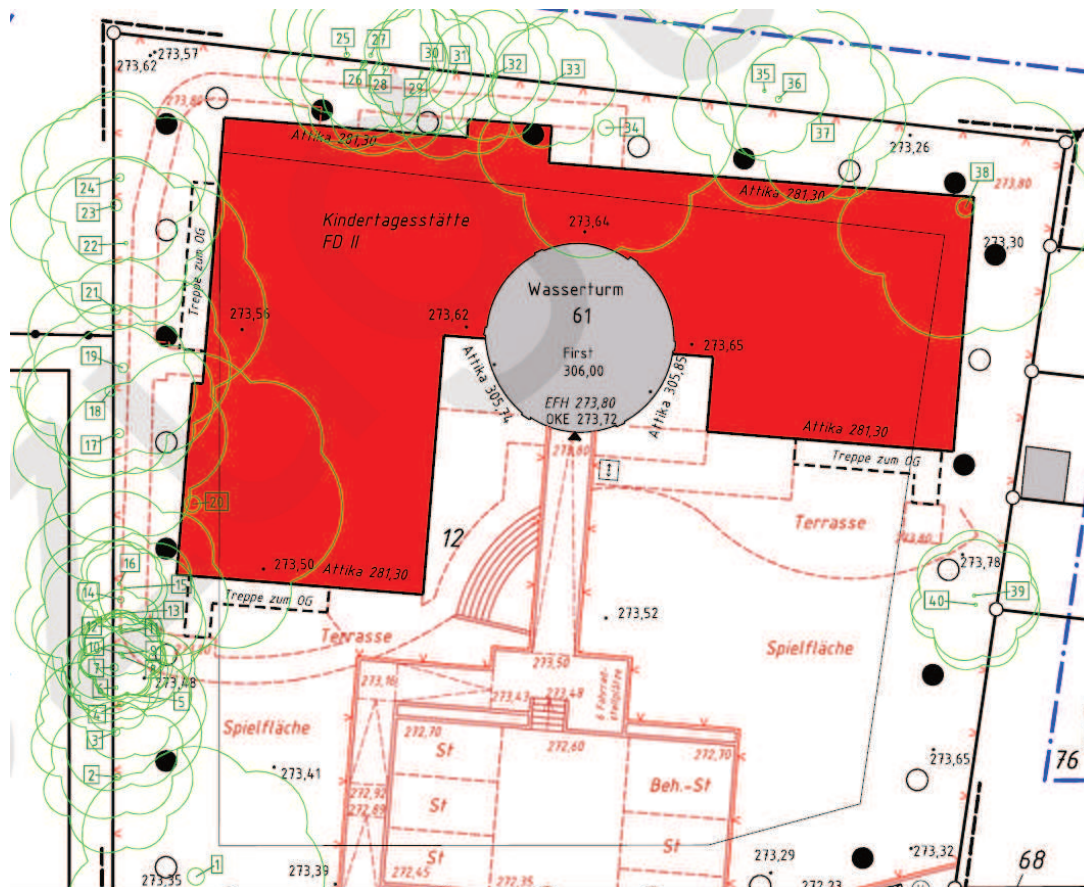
Lageplan mit eingetragenen Baumstandorten, Stand: November 2022
